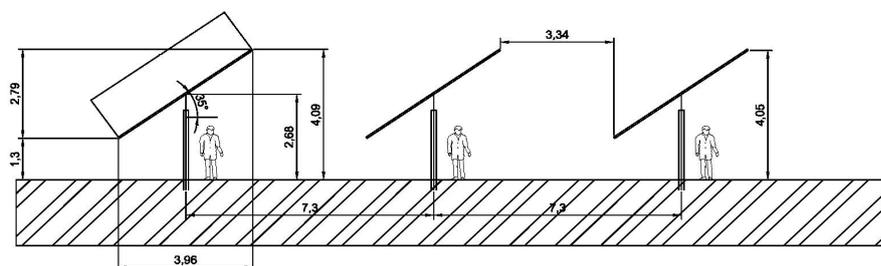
Quote e distanze dal suolo delle strutture fisse (inclinazione a 35°)
